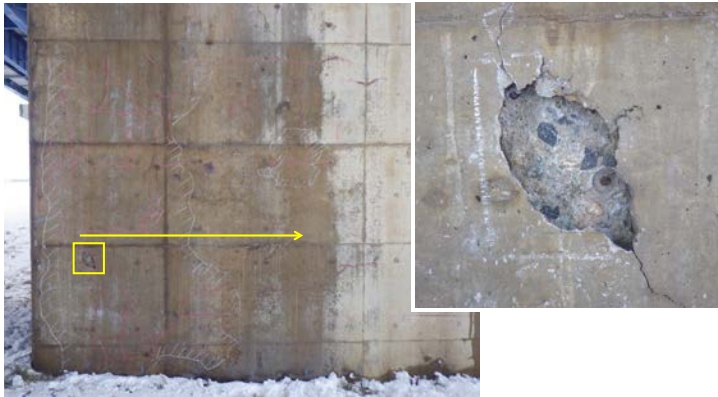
C橋橋脚のひび割れと浮き、剥離 (写真-1の右橋脚の左下拡大、右上写真は実線四角部分の拡大、矢印は浮きのレーダ探査位置)
